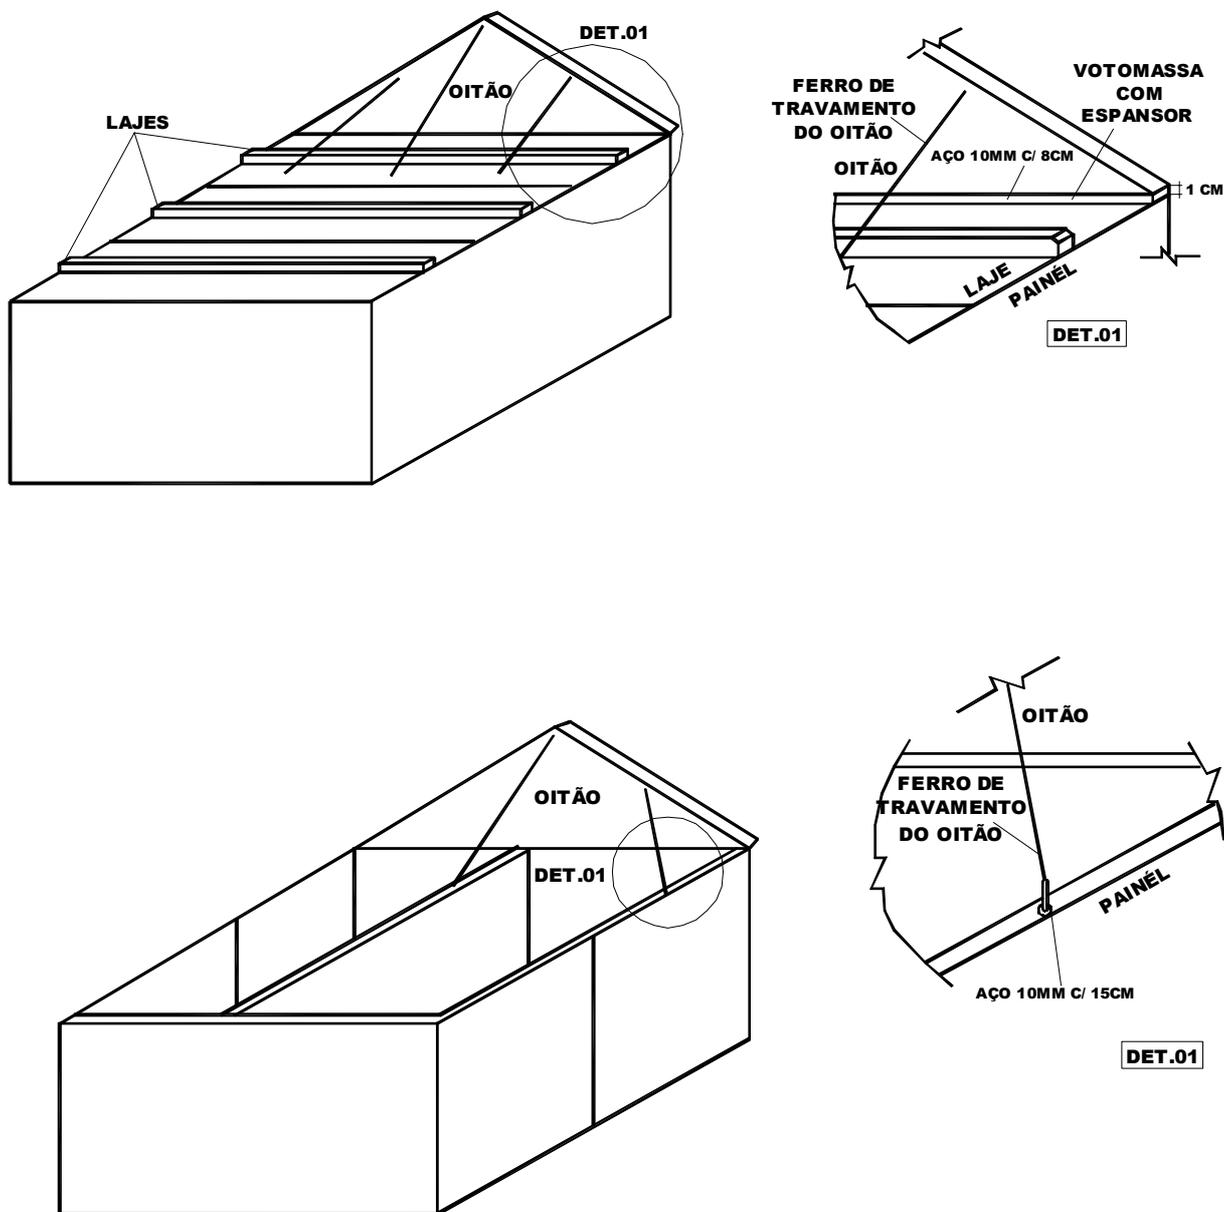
Detalhe do travamento dos oitões no sistema Jet Casa com ou sem a utilização de laje
